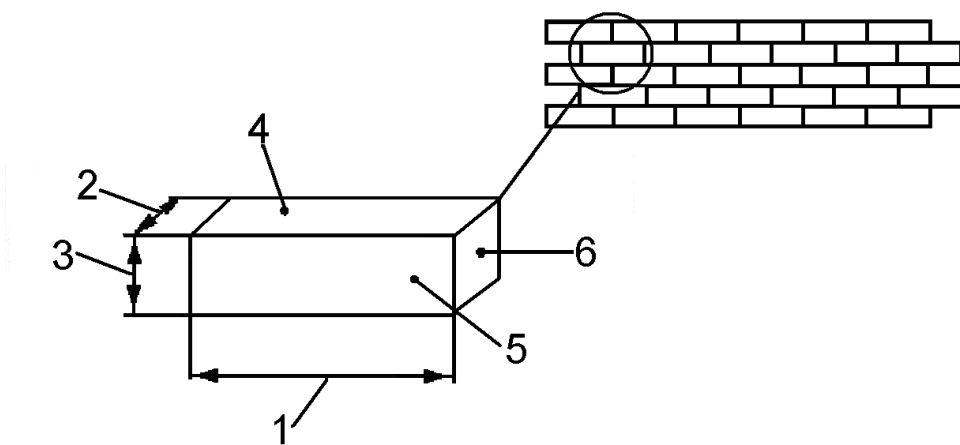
Bloc plan din beton celular autoclavizat GBN 25
